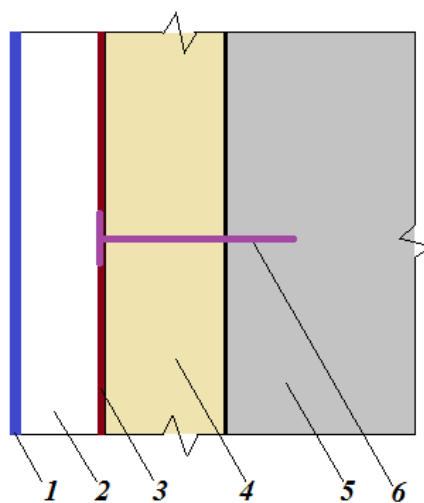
Схема фасадной системы с вентилируемым зазором:
